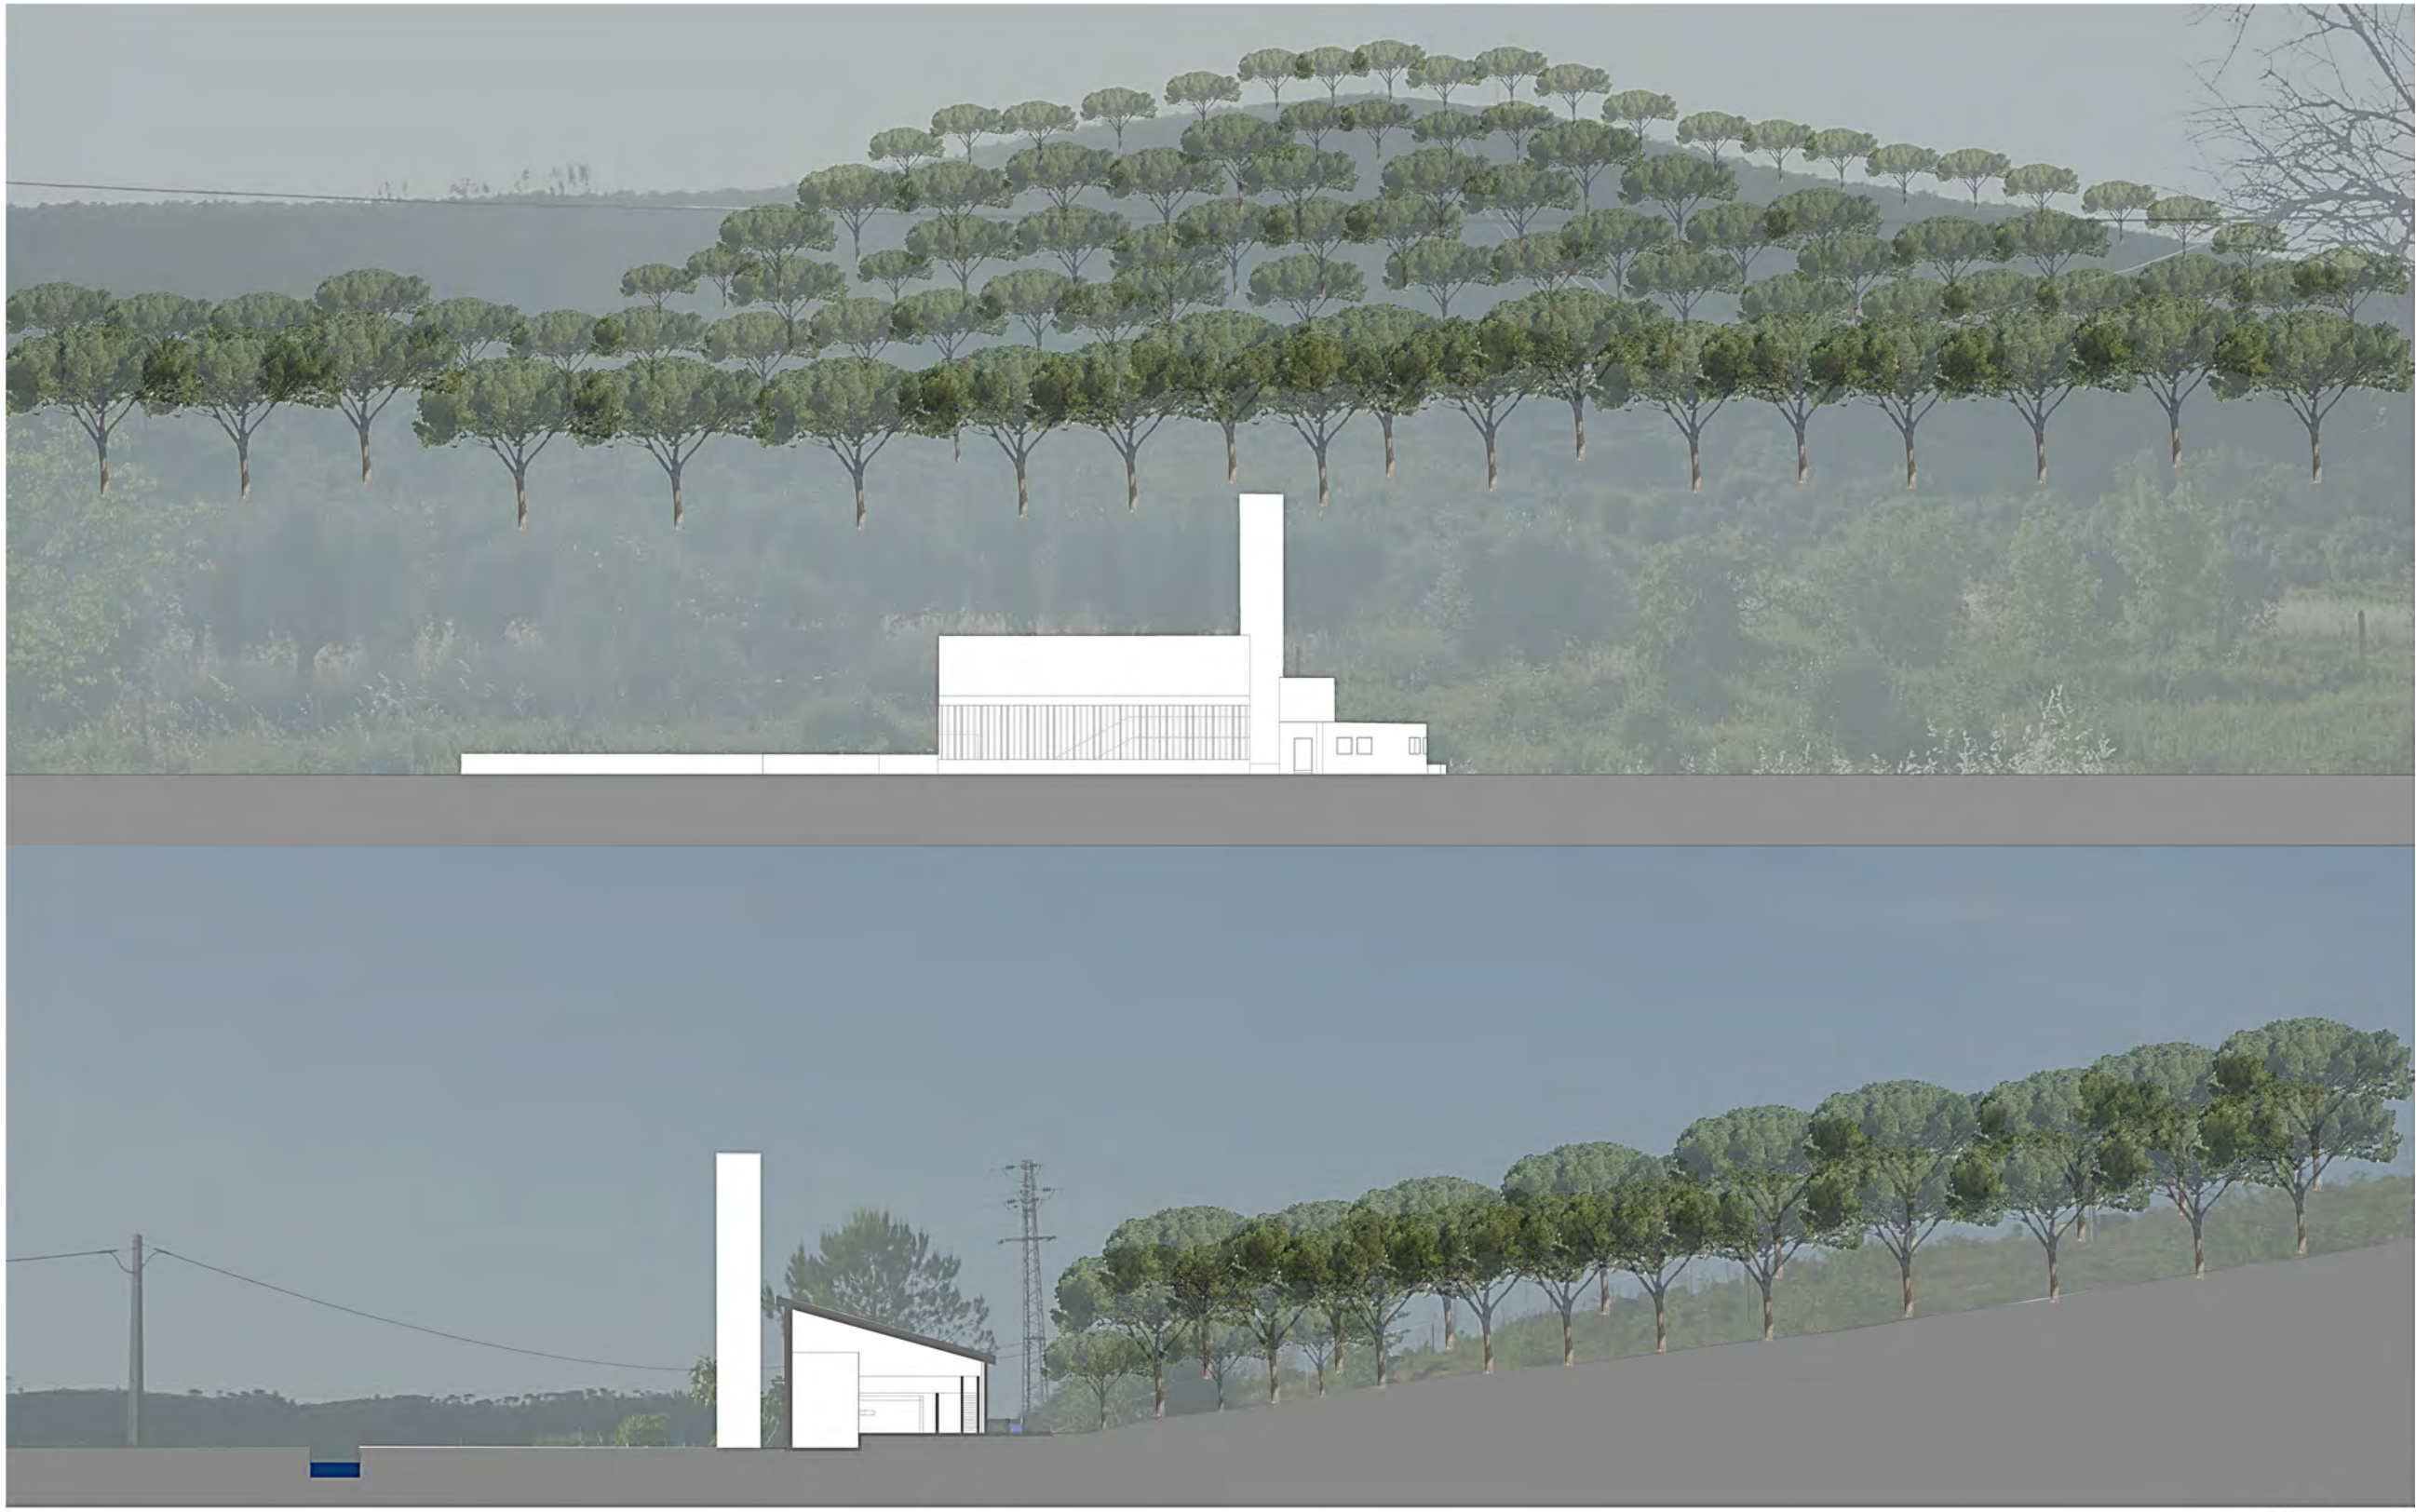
Alçado Oeste e Corte transversal vista Norte
